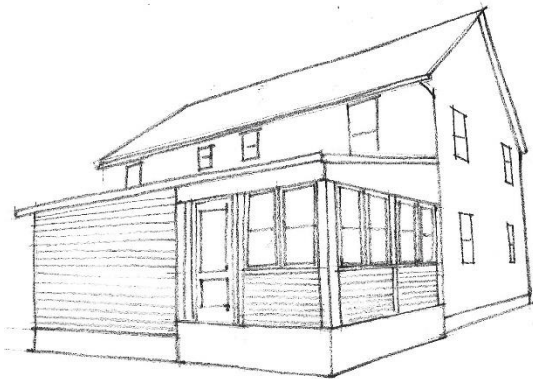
Volumétrie des galeries surplombées de toits et garde-corps, poteaux, marches et contremarches
